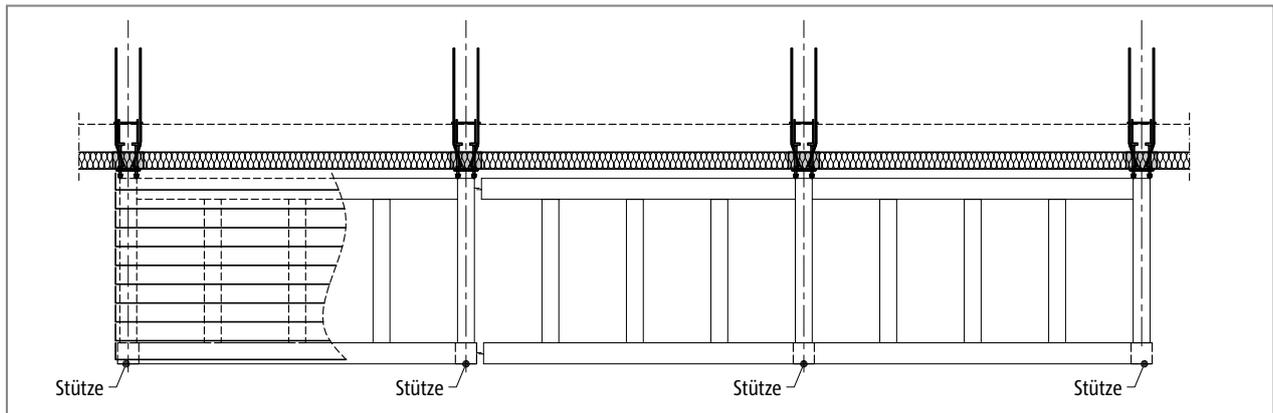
Schöck Isokorb® XT Typ SQ: Balkon mit Stützenlagerung
